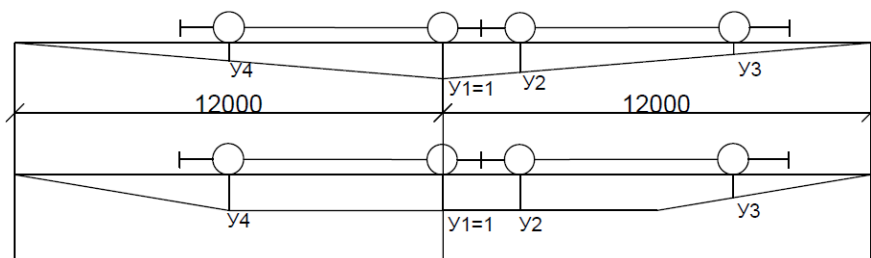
Схема к расчету колонны на крановую нагрузку
